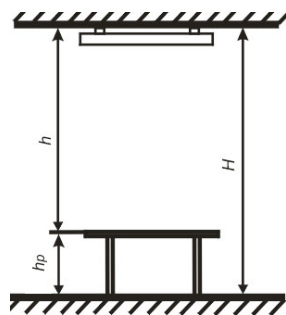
Схема розташування світильника над робочою поверхнею
